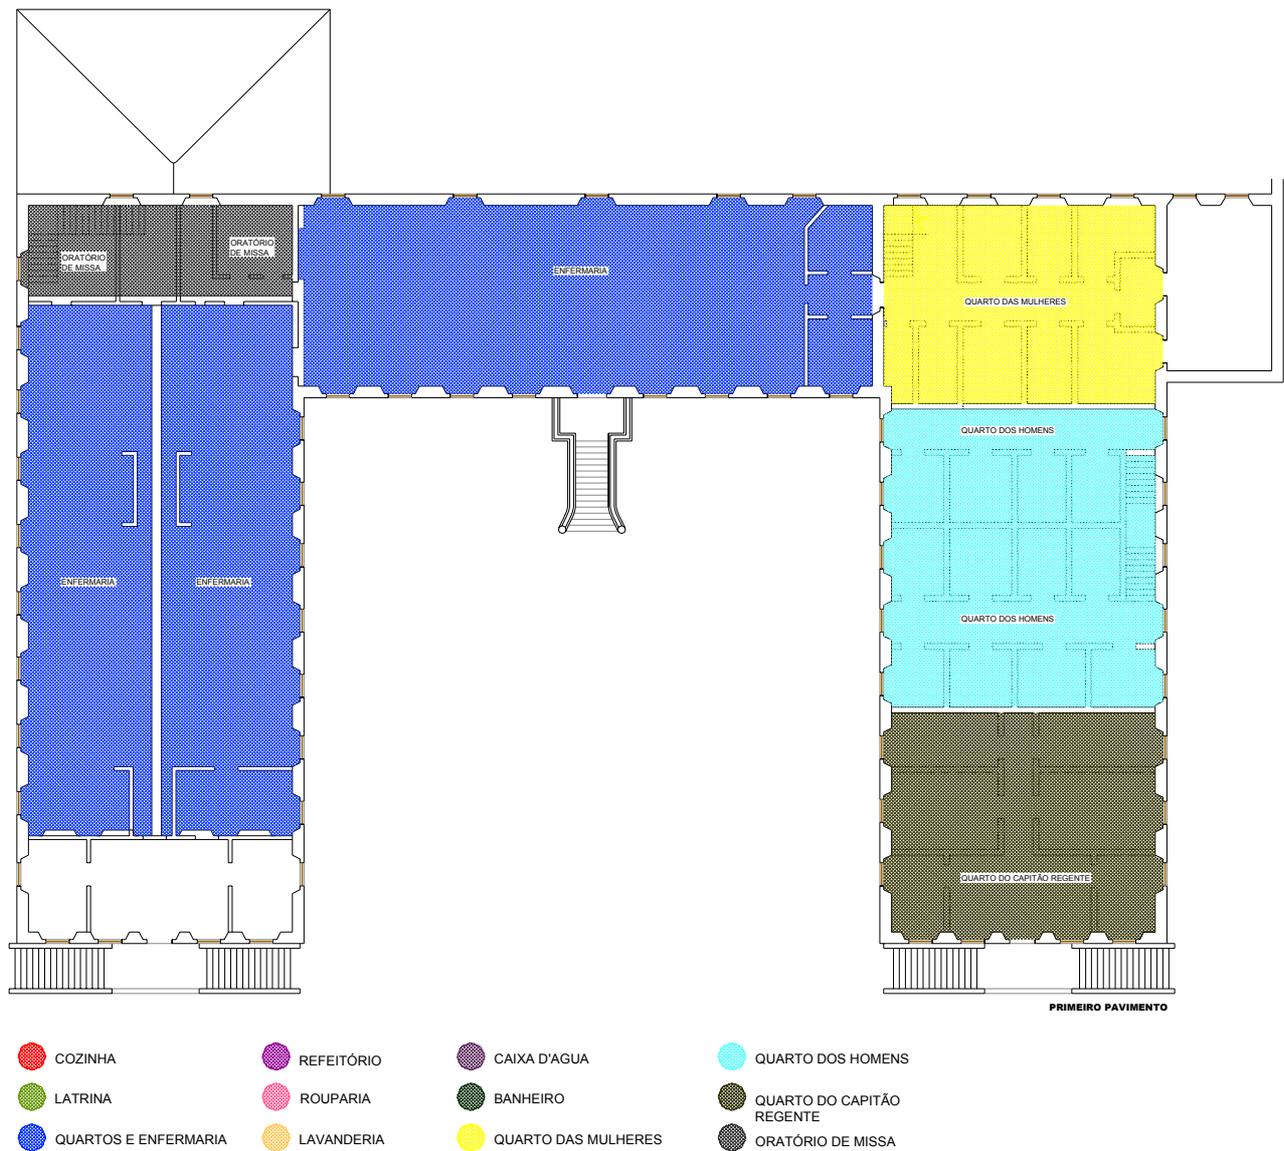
PLANTA DO HOSPITAL SÃO CRISTOVÃO DOS LÁZAROS – PRIMEIRO PAVIMENTO
